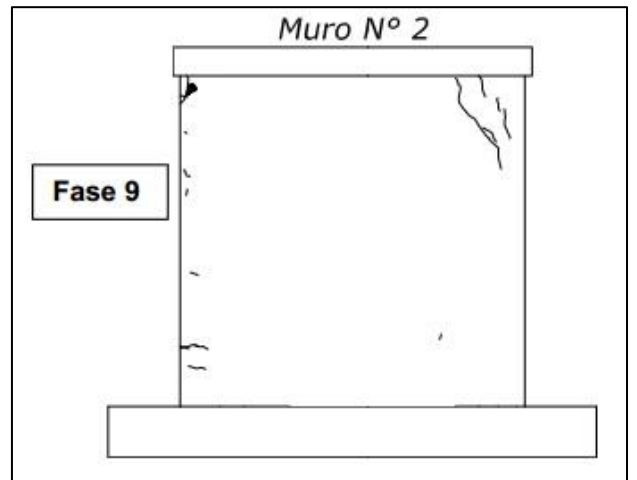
Fisuras muro M-2 en fase 9.
